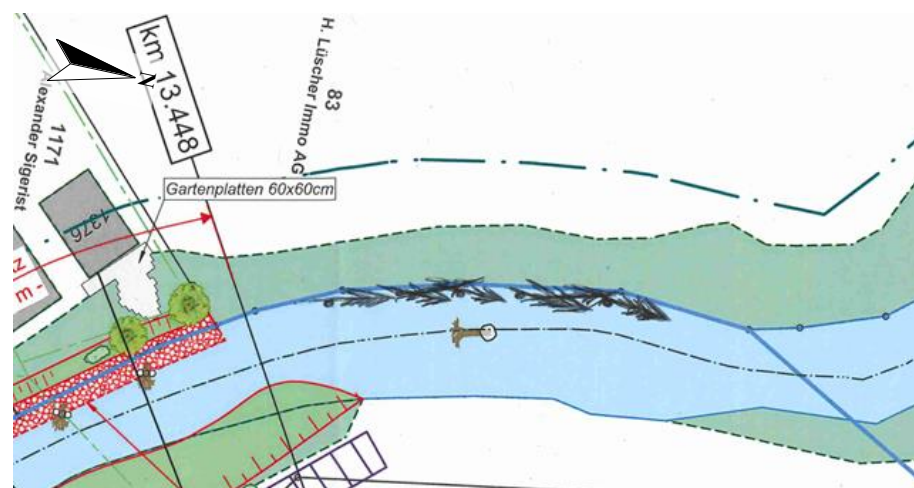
Entwurf Platzierung Raubäume in Gerinne, Kissling + Zbinden AG, Planstand 10.09.2025
